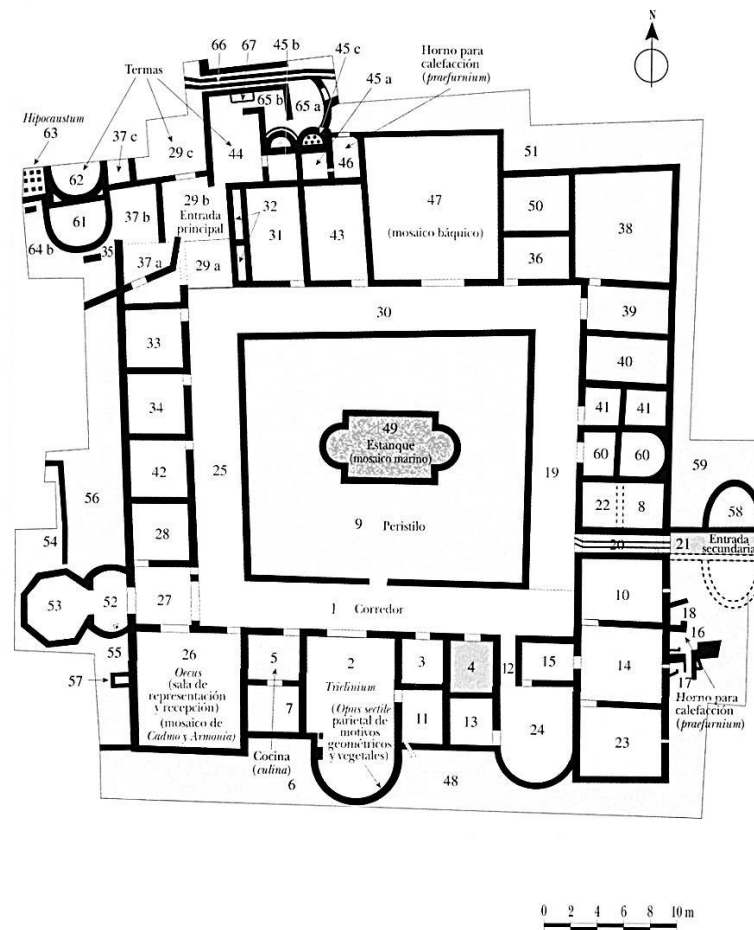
Planimetría de la villa de La Malena (Azuara, Zaragoza).
